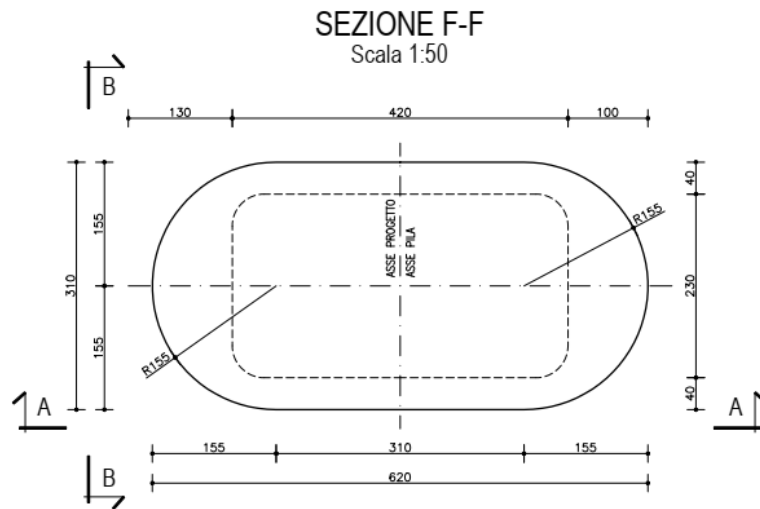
Sezione orizzontale alla base delle pile P2 e P3
